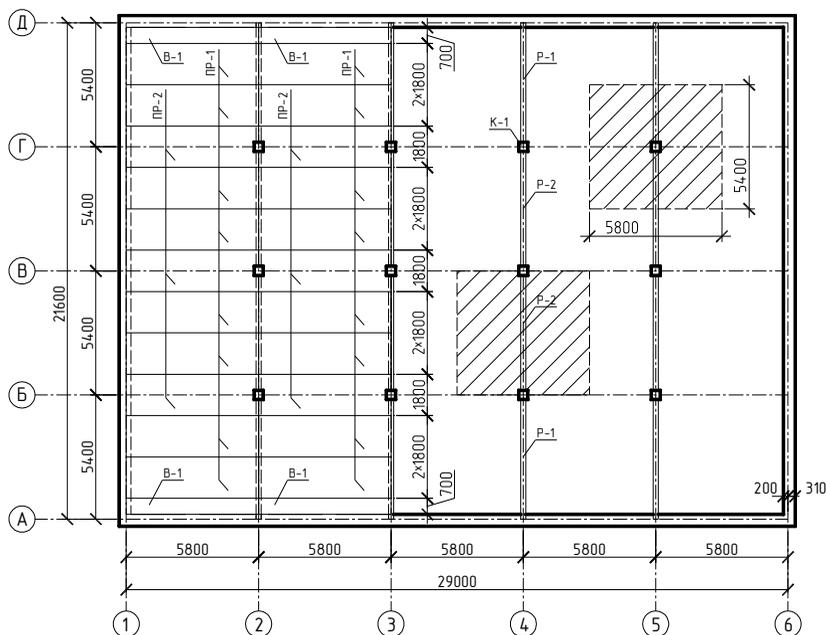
Компоновка конструктивной схемы сборного перекрытия
